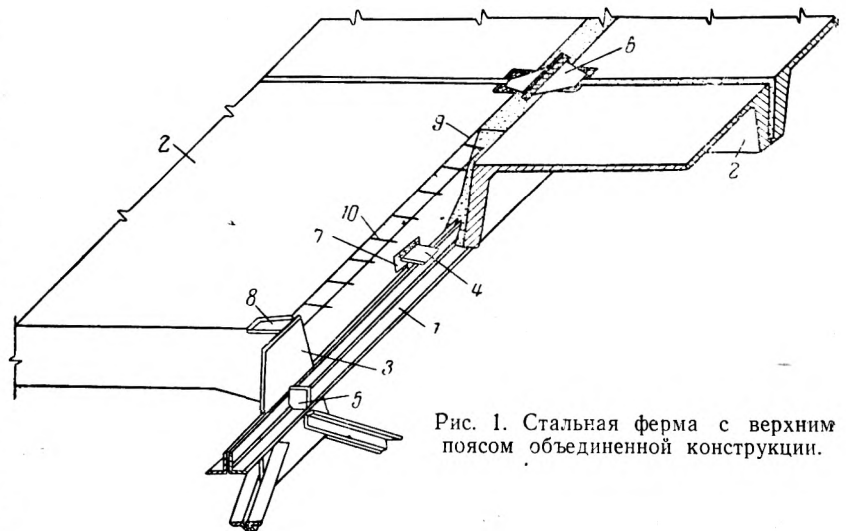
Стальная ферма с верхним поясом объединенной конструкции.
